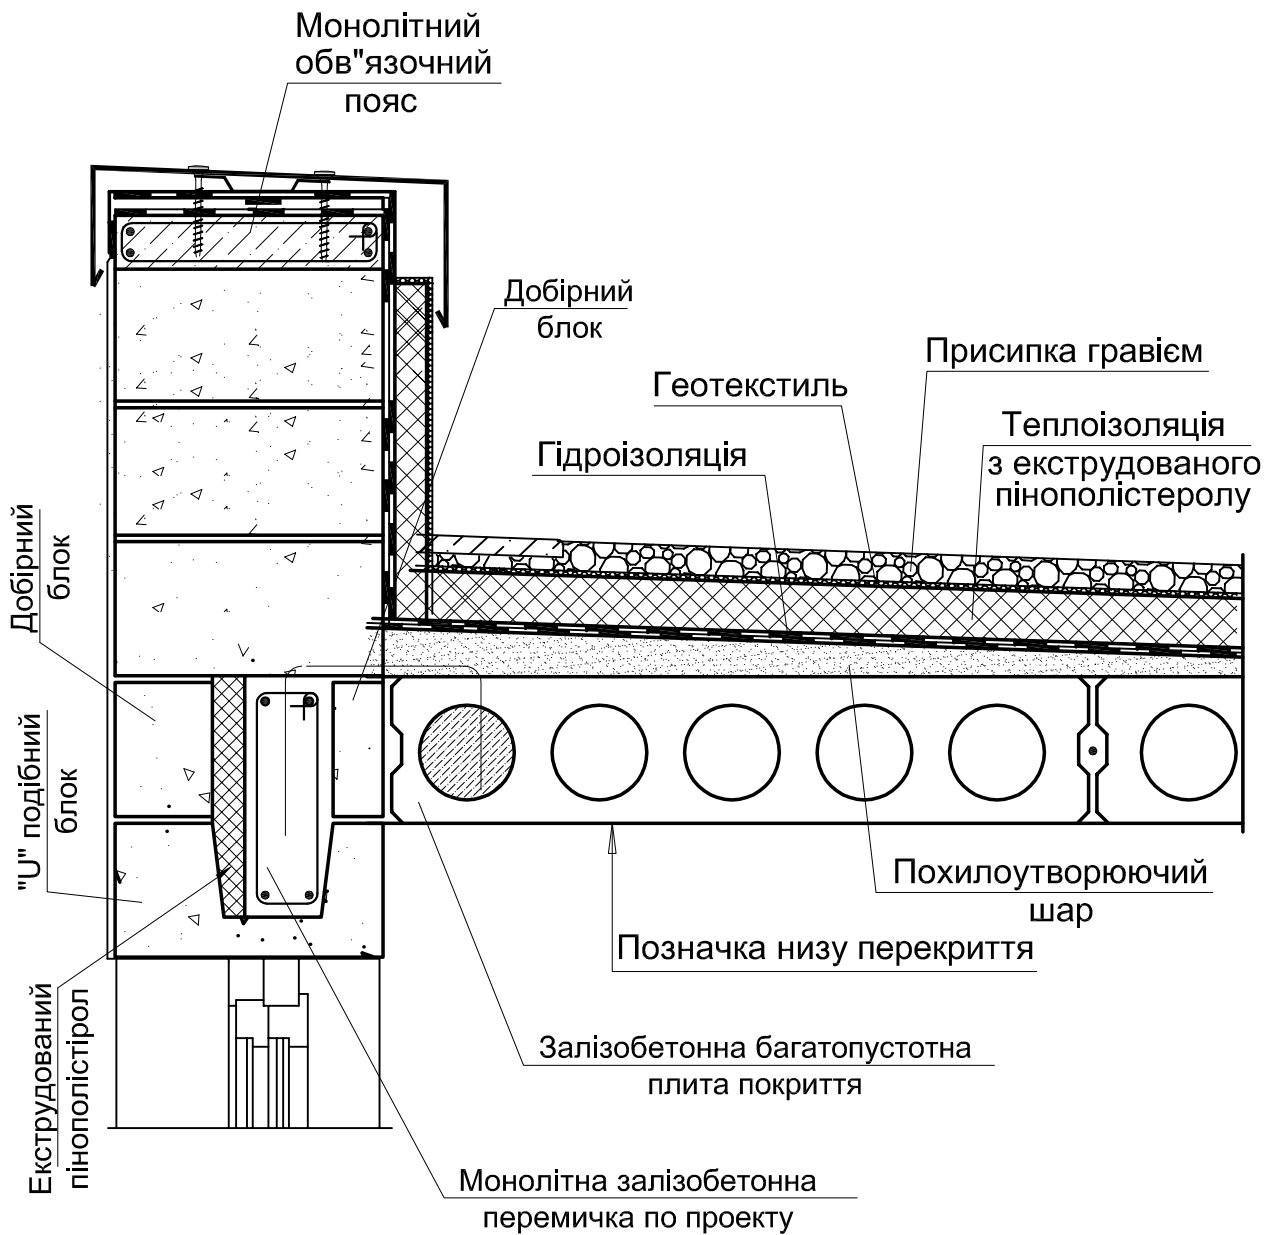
Конструювання утепленого плоского даху над збірним багатопустотним покриттям. Проекція поперек несучих плит
